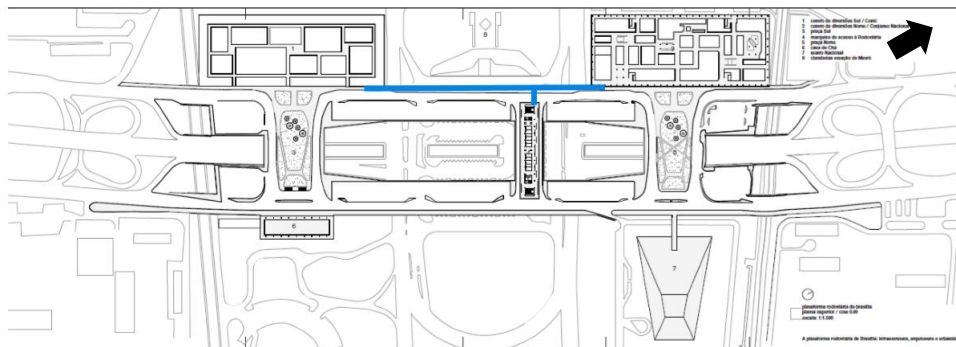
Planta Pavimento Superior - Rodoviária.
